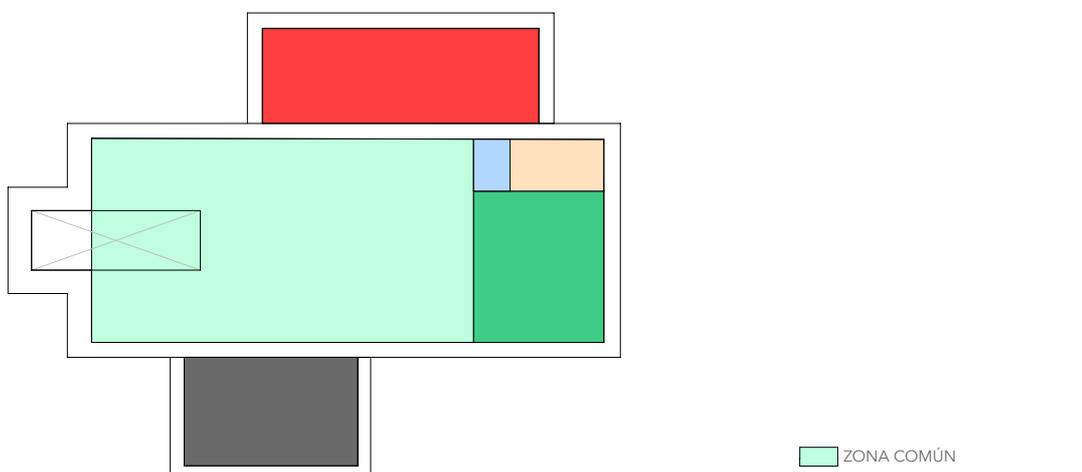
Planteamiento 3 de la distribución planta baja.
